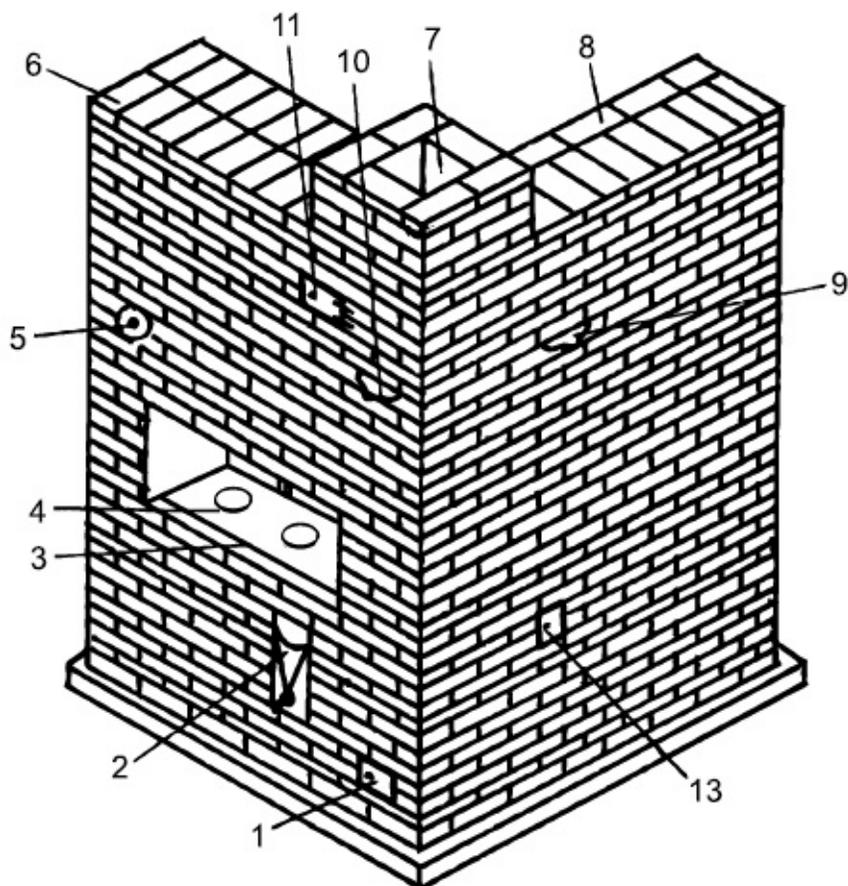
Русская печь: 1, 13 – чистка; 2 – водогрейная коробка; 3 – шесток; 4 – чугунная плита; 5 – самоварник $d=100$ мм; 6 – перекрыша; 7 – труба; 8 – перекрыша щитка обогревательного; 9, 10 – задвижки; 11 – вьюшка, закрываемая дверкой; 12 – гидроизоляция (см. рисунок 47)
